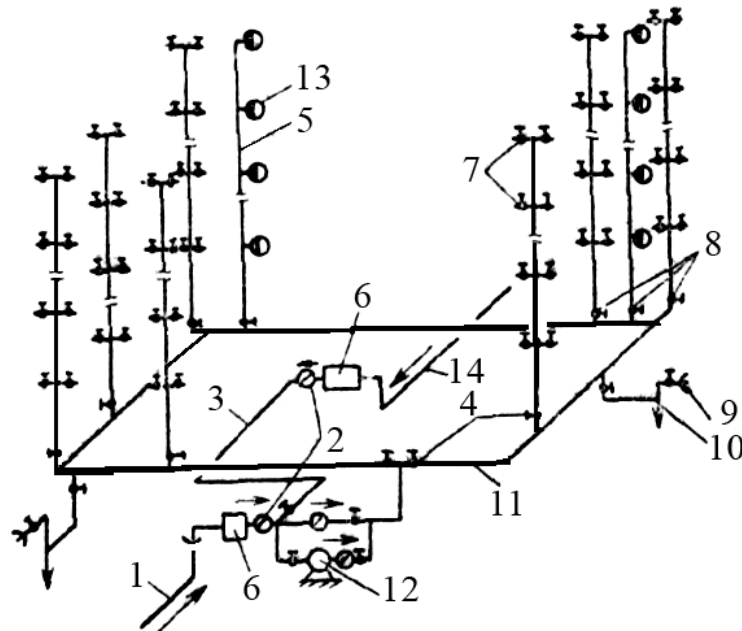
Система водоснабжения здания с повысительной насосной установкой:
